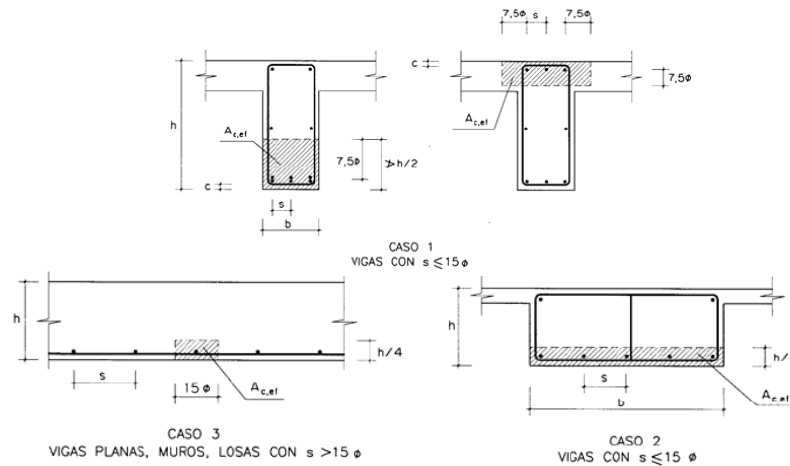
E.L.S. de Fisuración. Parámetro  $A_{x,eficaz}$ , EHE [1].
